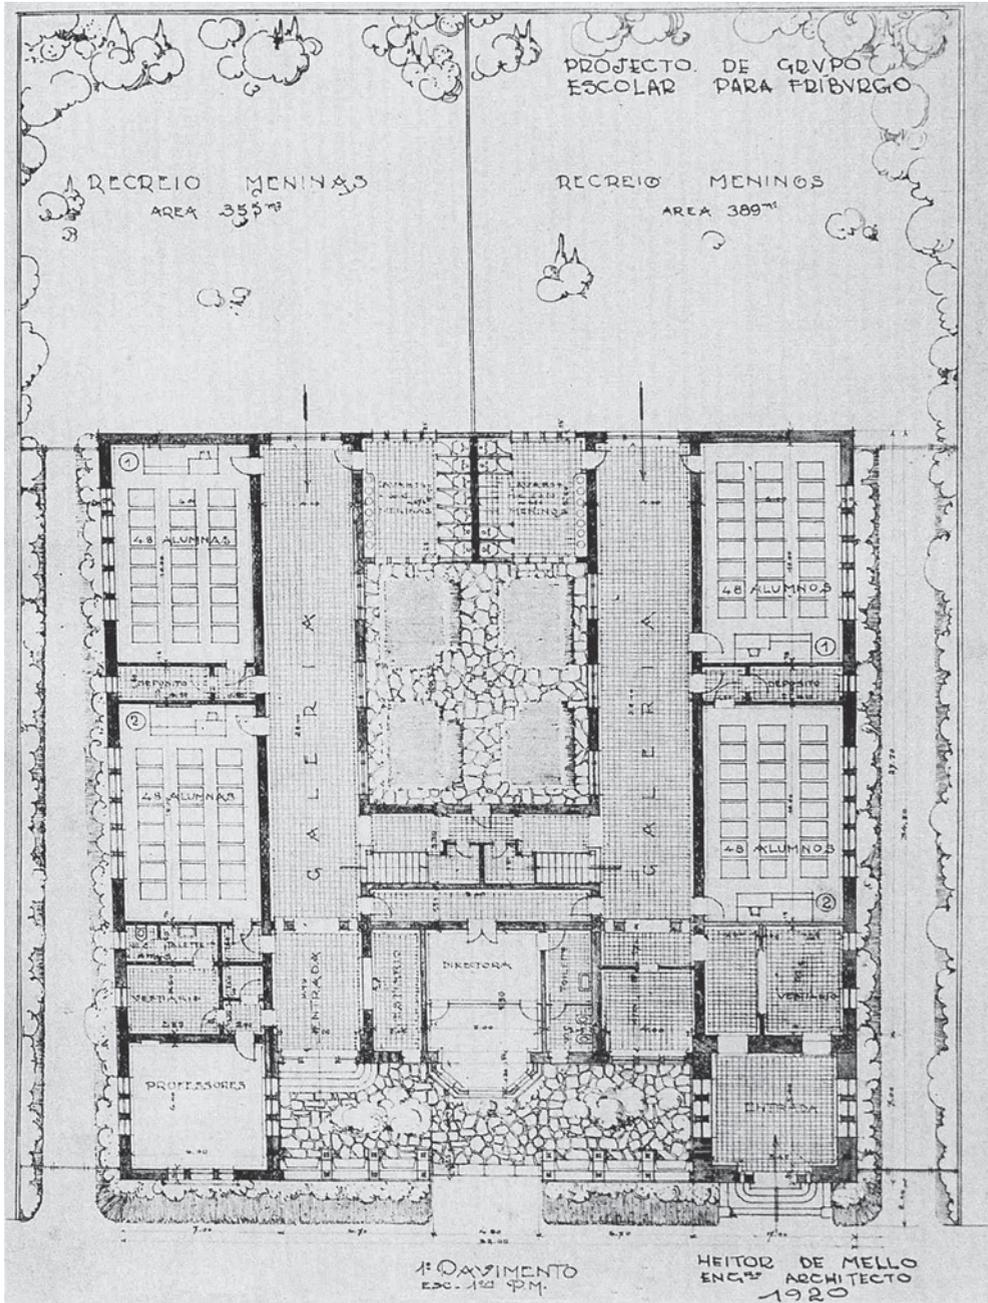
Grupo Escolar de Nova Friburgo: Planta baixa do primeiro pavimento
